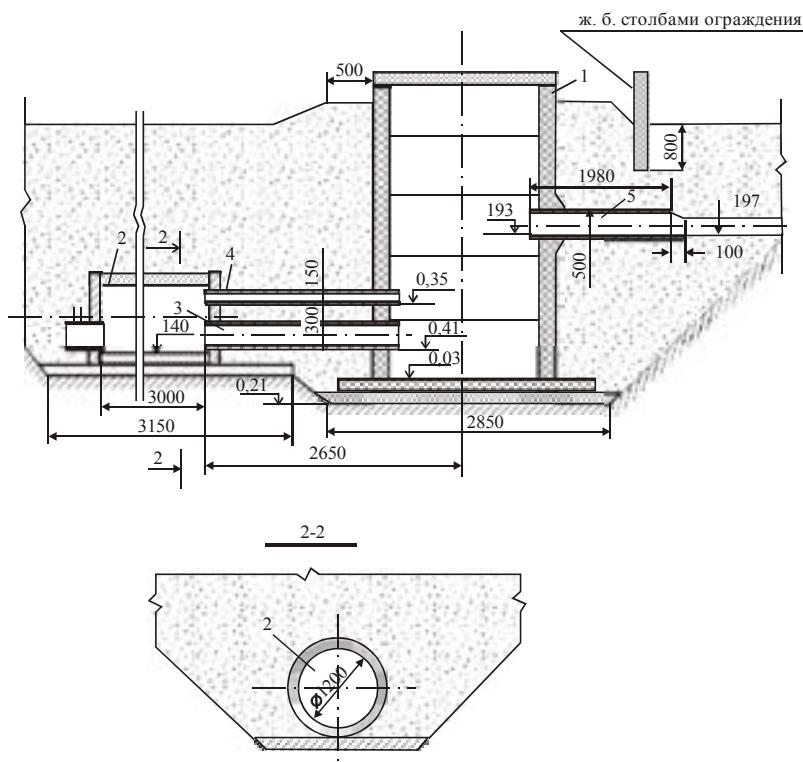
Колодец-накопитель из железобетонных труб: 1 – вертикальный колодец из железобетонных колец; 2 – горизонтальные трубы в лучах-траншеях; 3 – соединительная труба; 4 – воздуховыпускная труба; 5 – коллектор.
